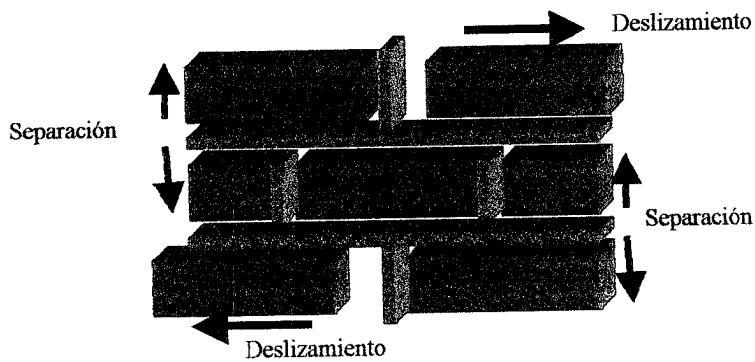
Separación y deslizamiento en las juntas de mortero.
